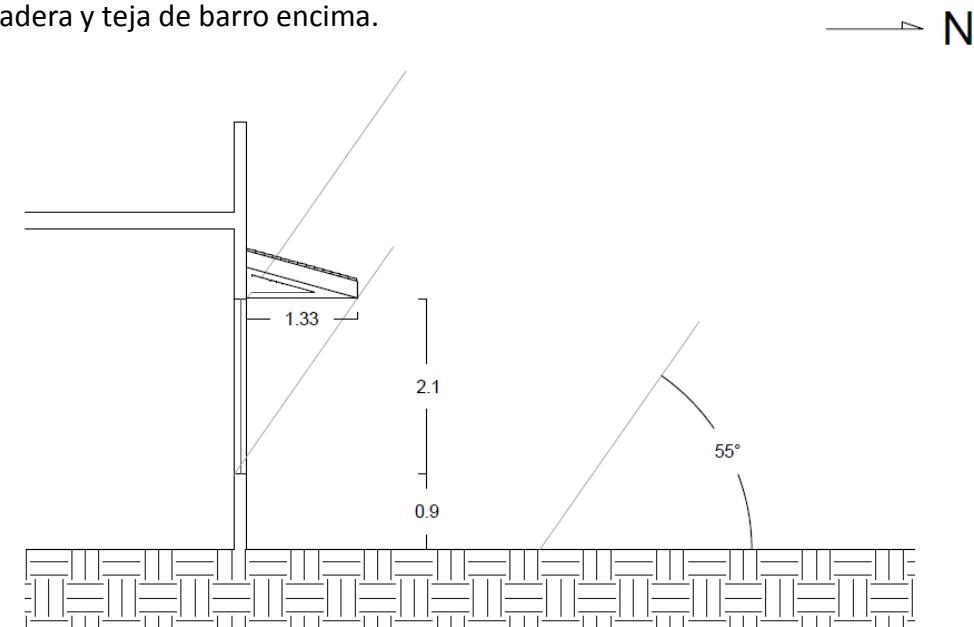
Propuesta de Dispositivos de Control Solar en Fachadas Norte.
